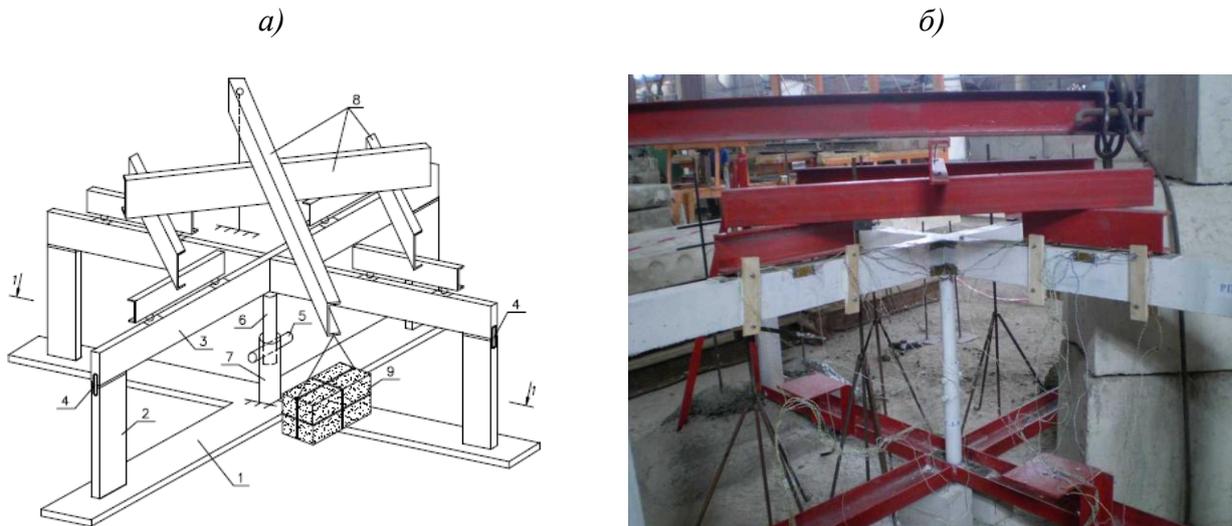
Испытание пространственной конструктивной системы: а – схема перекрестных рам (1 – опорная балка; 2 – стойки; 3 – ригели; 4 – соединительные элементы; 5 – бетонная шпонка; 6, 7 – телескопическая конструкция из двух металлических труб; 8 – рычажная система; 9 – грузовая платформа); б – общий вид испытаний
